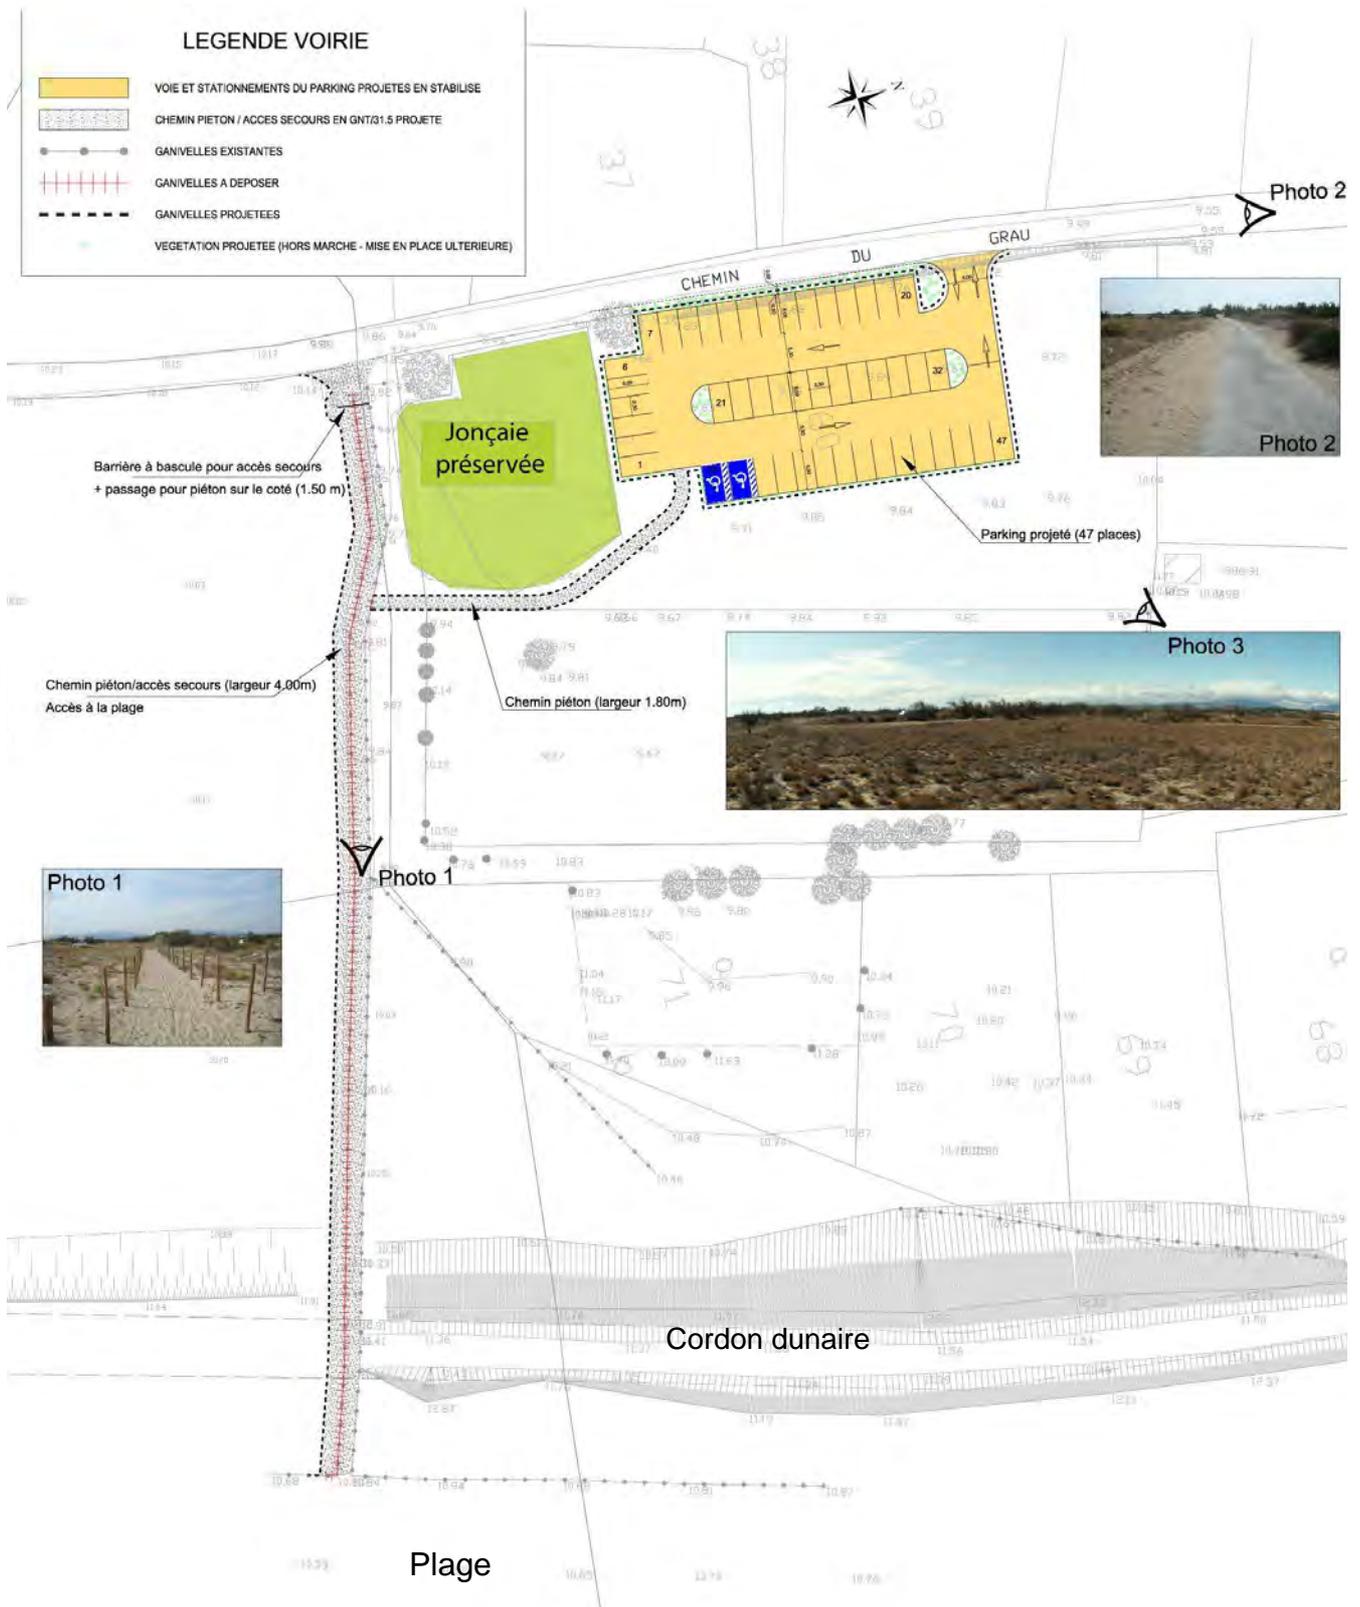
plan de masse du projet d'aire d'accueil, du cheminement piéton et de la piste d'accès à la plage
